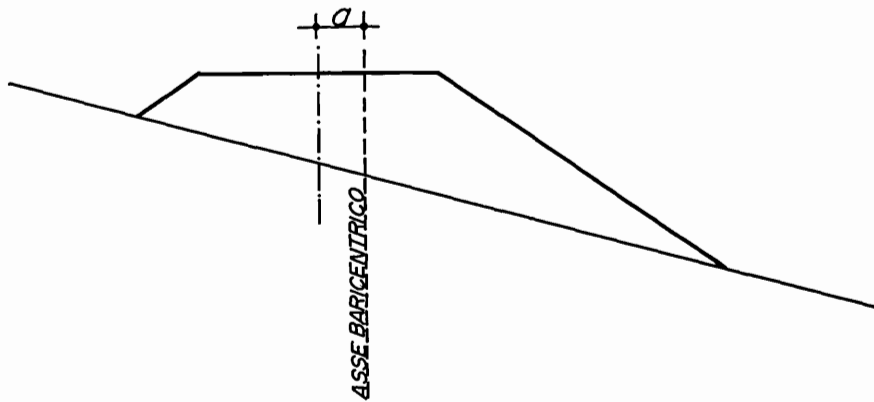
Posizione del baricentro rispetto all'asse in una sezione in rilevato.
